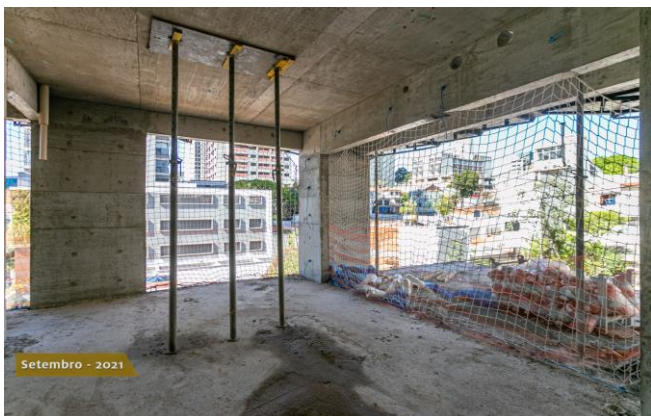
Laje e vigas de concreto em pavimento finalizadas.
